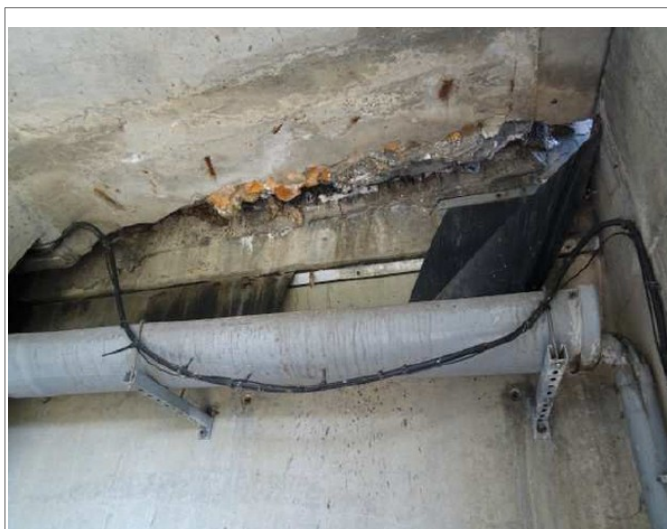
Jupe arrachée au droit du joint de chaussée - Culée Digoin côté La Roche
